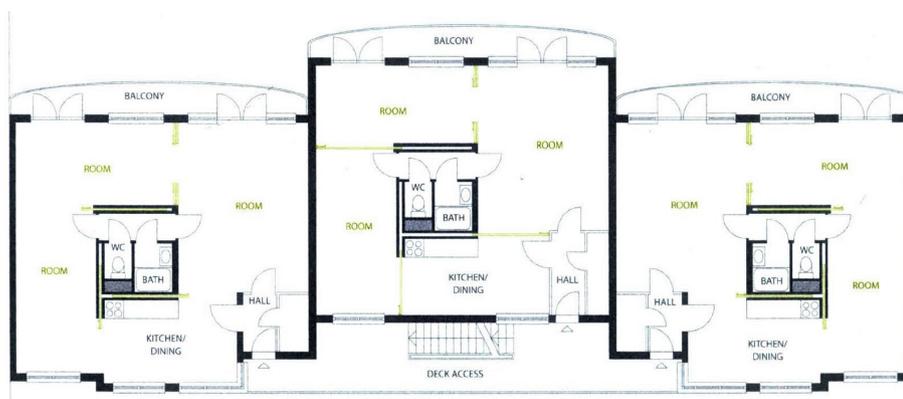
Planta de um piso e possíveis configurações no Dapperbuurt.
